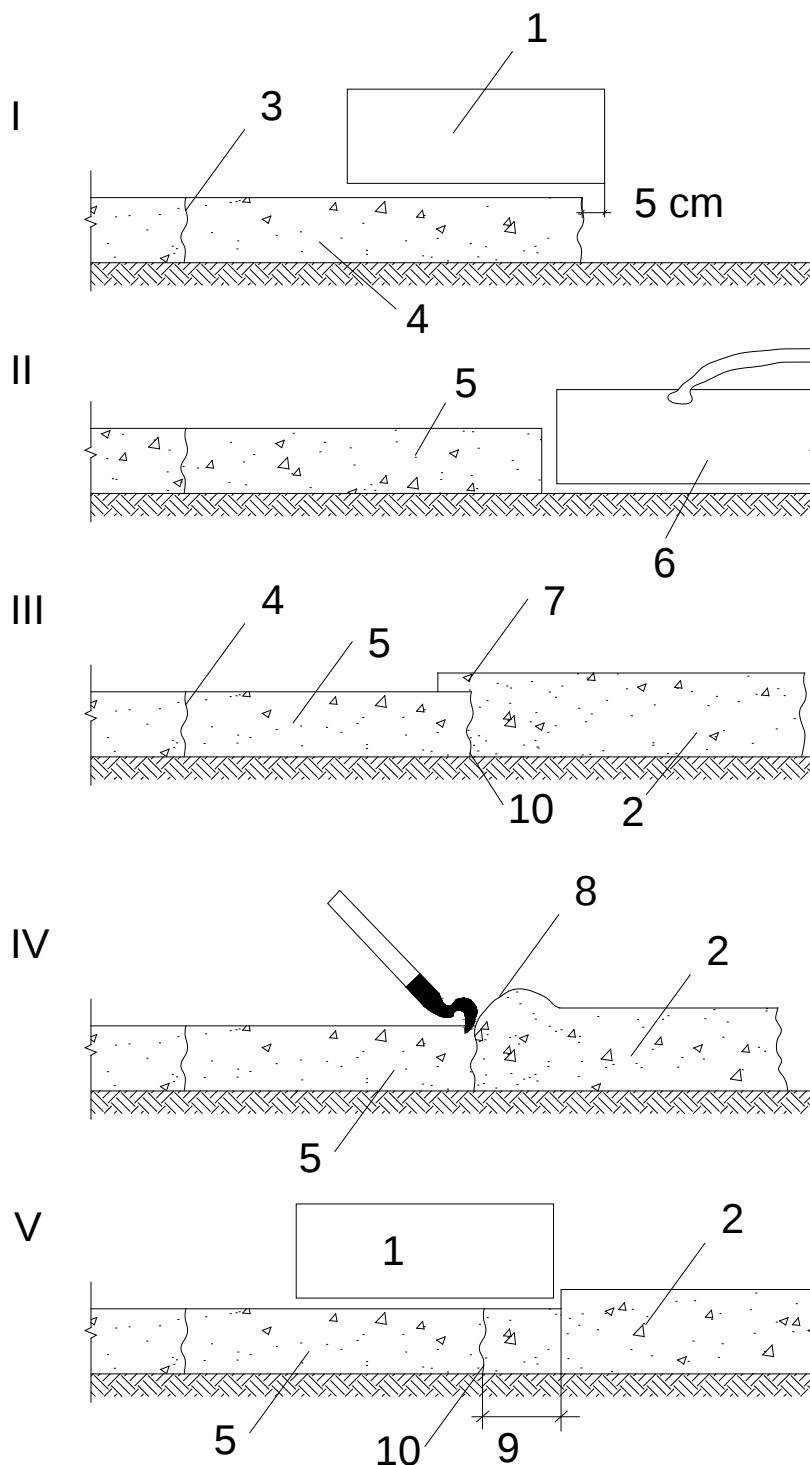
Schema de compactare a benzii longitudinale a fundației, aderentă la betonul întărit, cu executarea rostului longitudinal „rece”.
